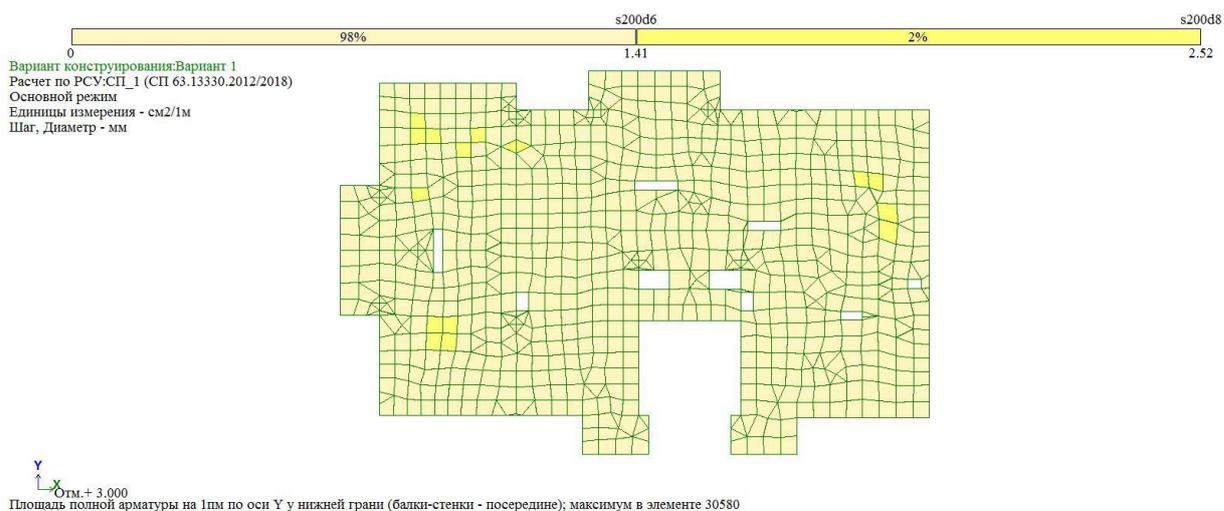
Нижняя арматура в плите перекрытия вдоль оси Y
